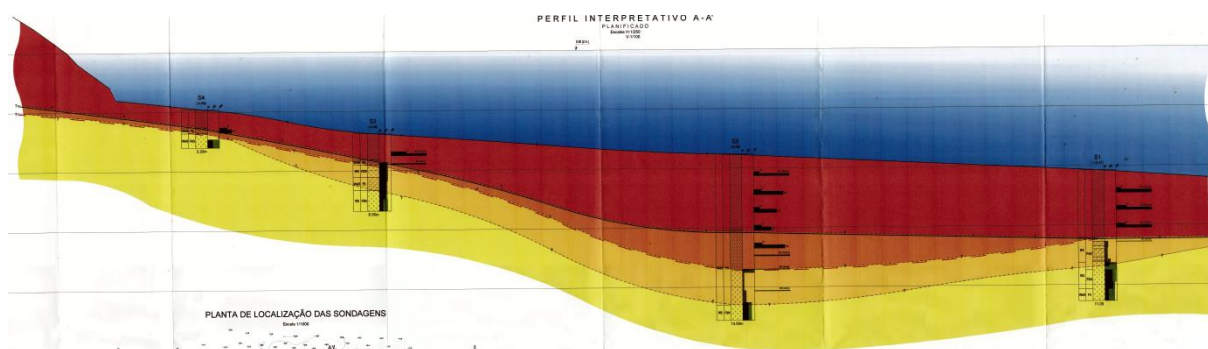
Perfil geotécnico interpretativo das Sondagens realizadas para a obra do Cais de Passageiros de Praia da Vitória (2004)
